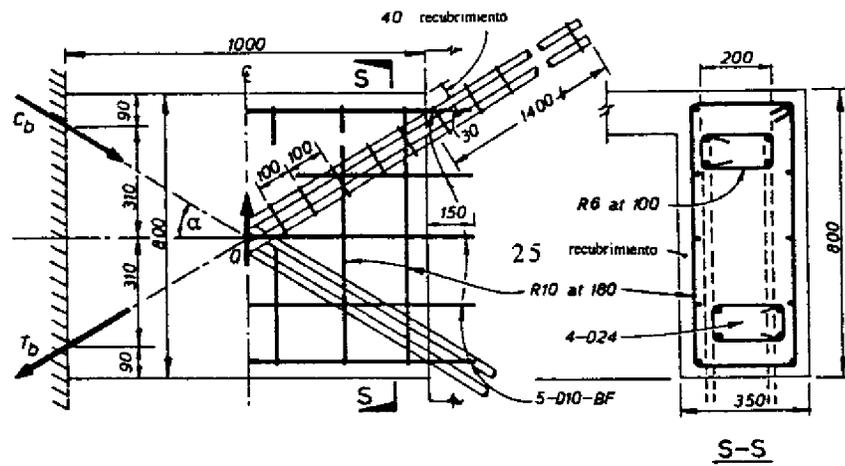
Detalles del refuerzo de una viga de acoplamiento
